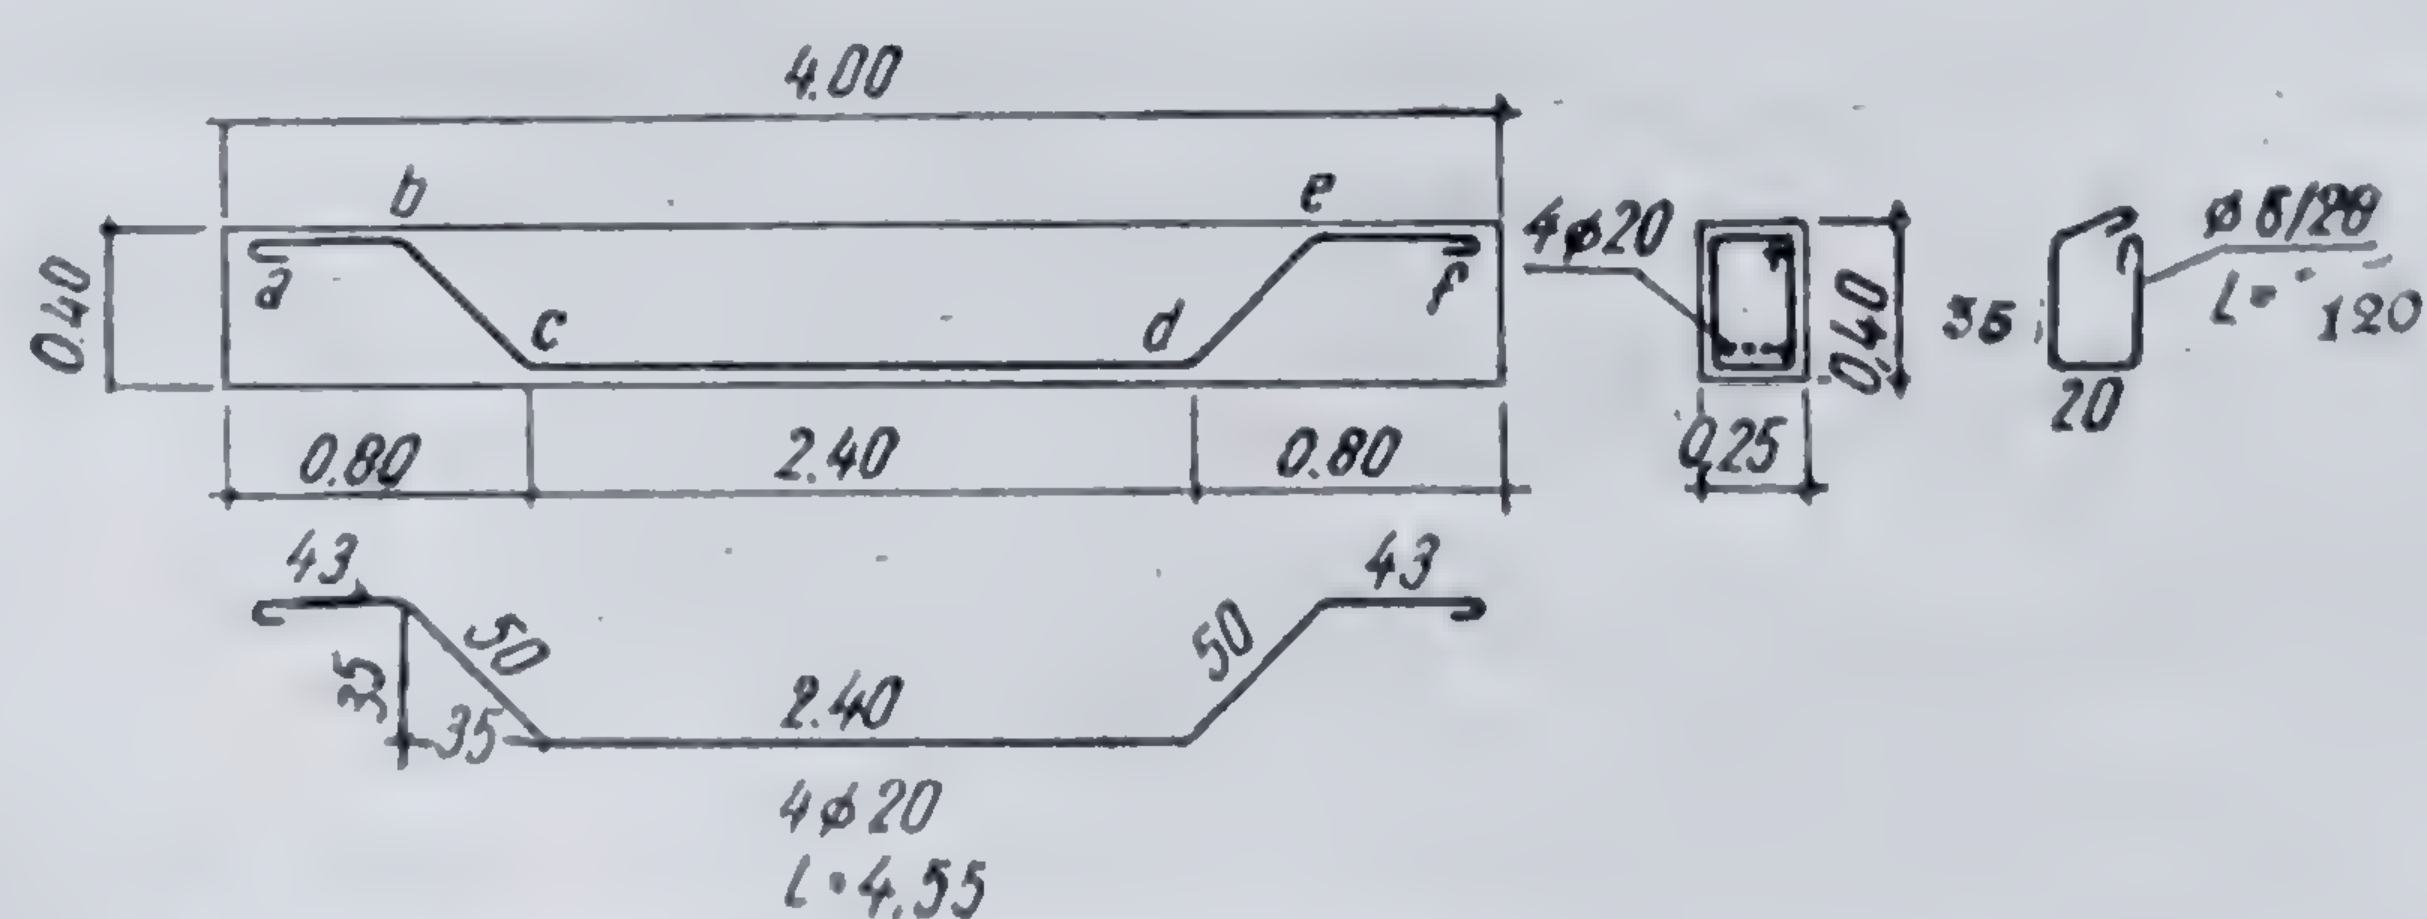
b. Grindă de beton armat. Extragerea armăturii.
